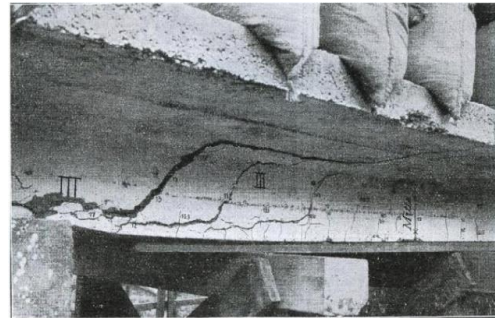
Patrón de falla en vigas T sin estribos (Mörsch, 1908).
